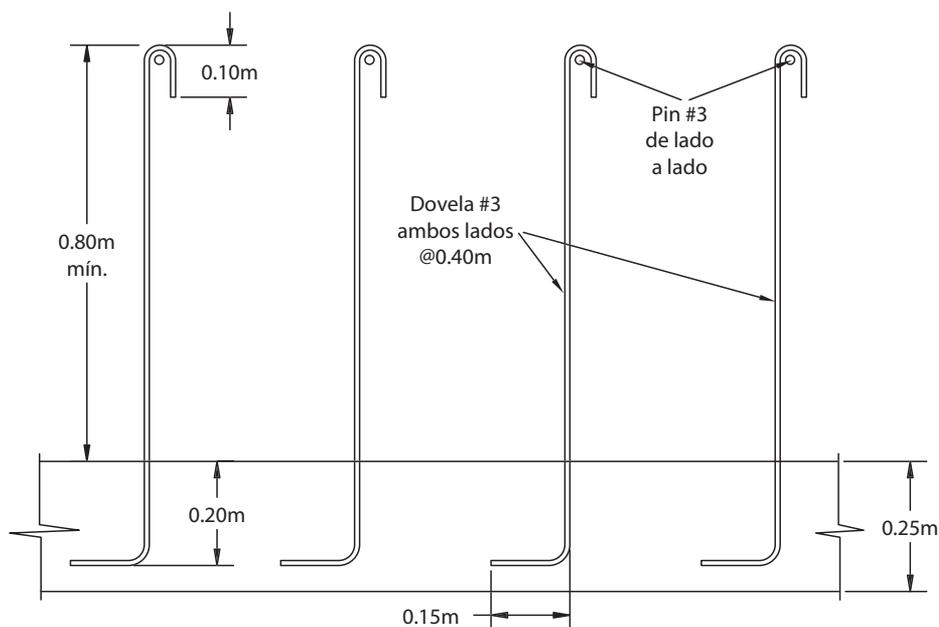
Detalle fundación para paredes tipo emparedado con malla tridimensional y relleno de espuma expandida.
